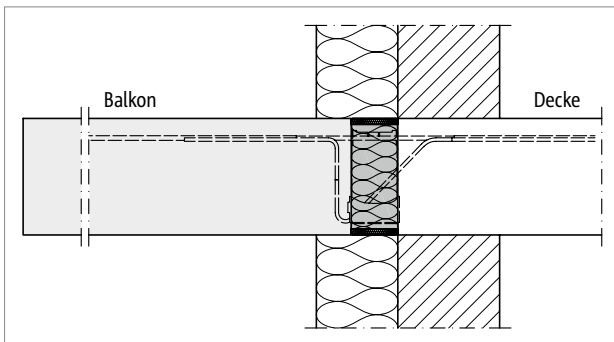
Schöck Isokorb® T Typ ZL, KL: Wärmedämmverbundsystem (WDVS)
